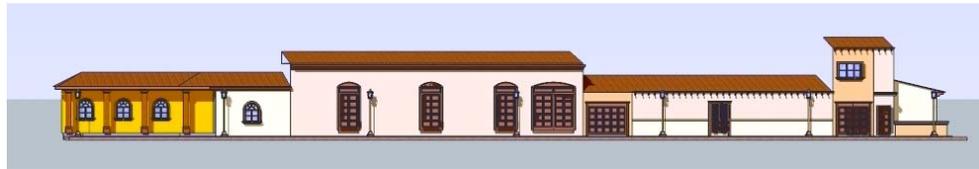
Vista Oriente - Avenida Irineo Chacón
